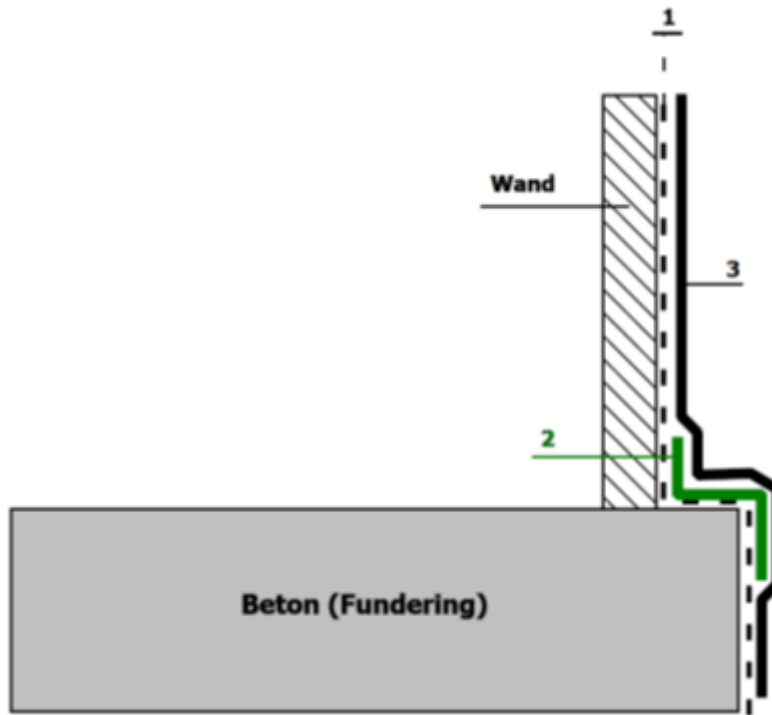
Detail overgang fundering / wand <sup>(1)</sup>
